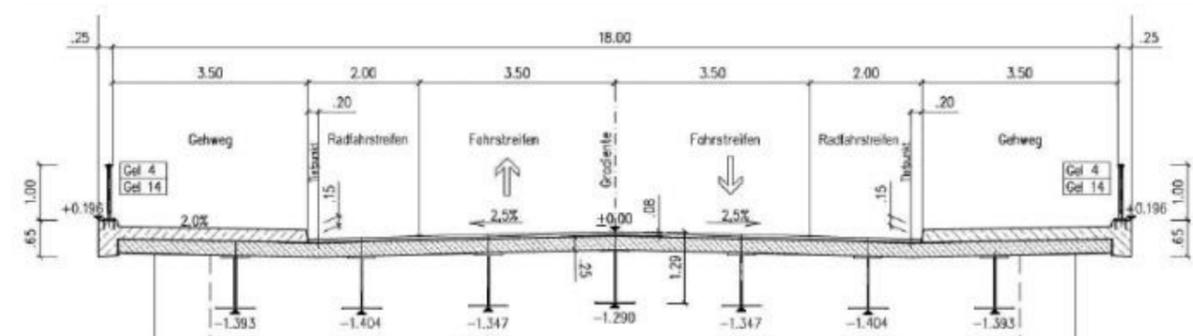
Sección tipo del Pliego de Condiciones, facilitado para el concurso.
